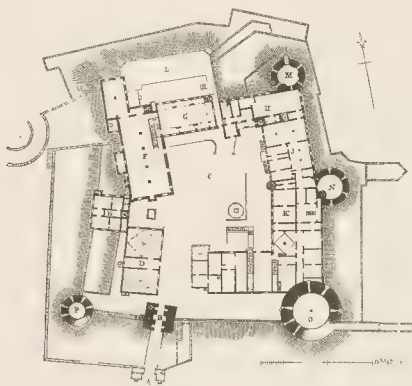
Grundriss des Heidelberger Schlosses
